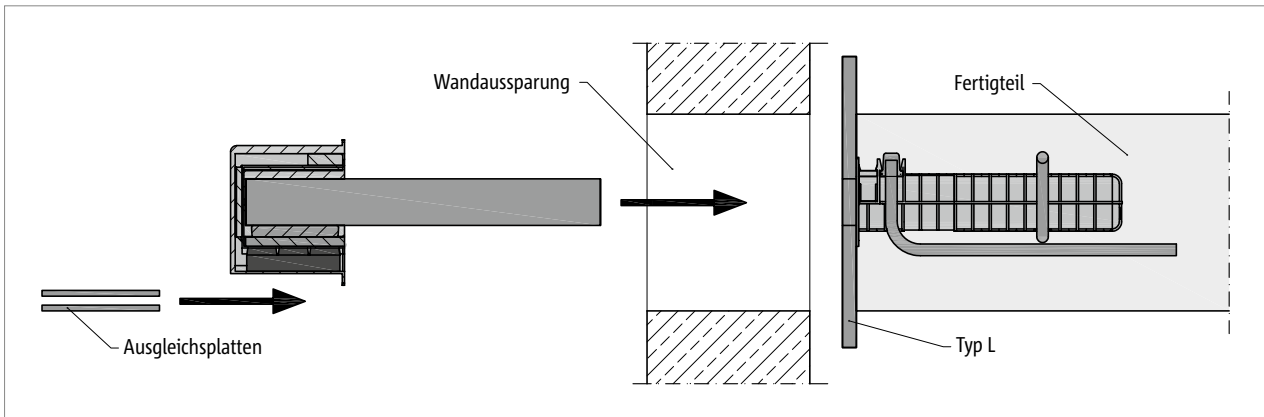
Schöck Tronsole® Typ Q: Wandaussparung bei Elementbauweise
